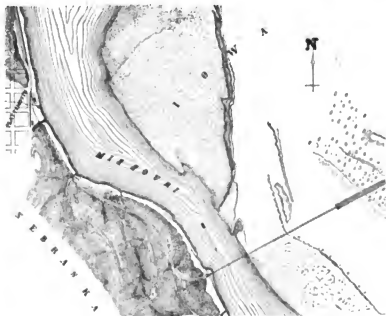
Lageplan der Missouri-Eisenbahnbrücke bei Plattsmouth.
